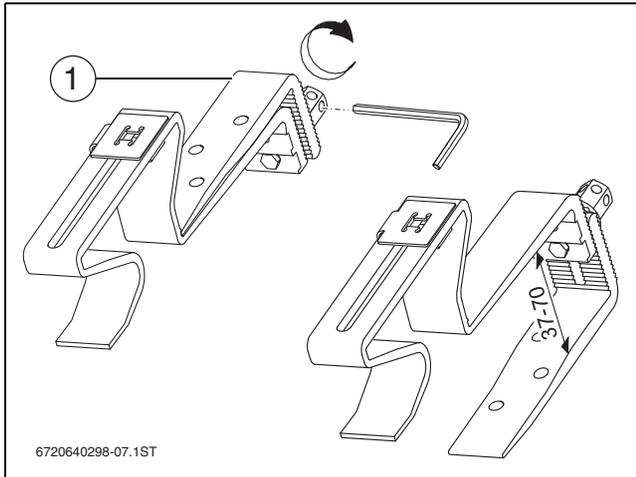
Girar la parte inferior de los ganchos de tejado, dimensiones en mm
